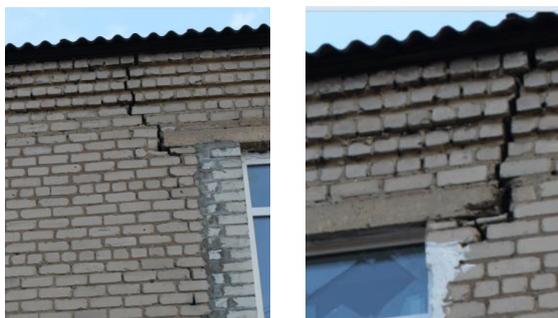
Сквозные наклонные трещины в наружной несущей стене здания
